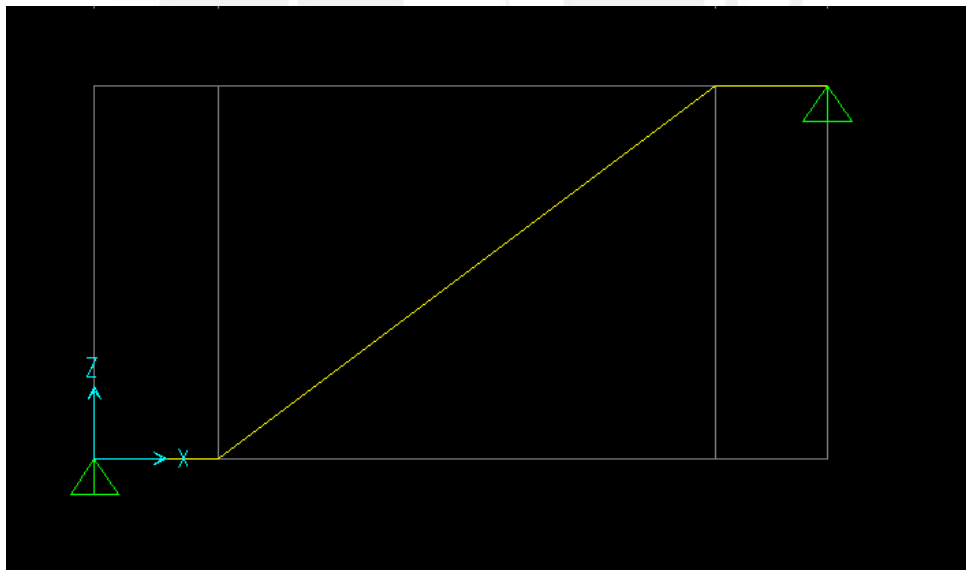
Modelo estructural empleado para el diseño de escaleras
